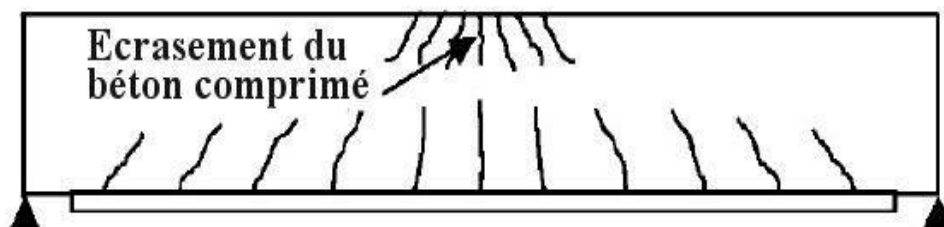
10. Rupture par écrasement du béton d'une poutre en BA renforcée.[46]
